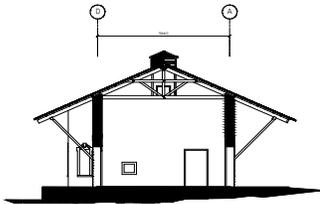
\_ Planos de levantamiento arquitectónico. Elevaciones
